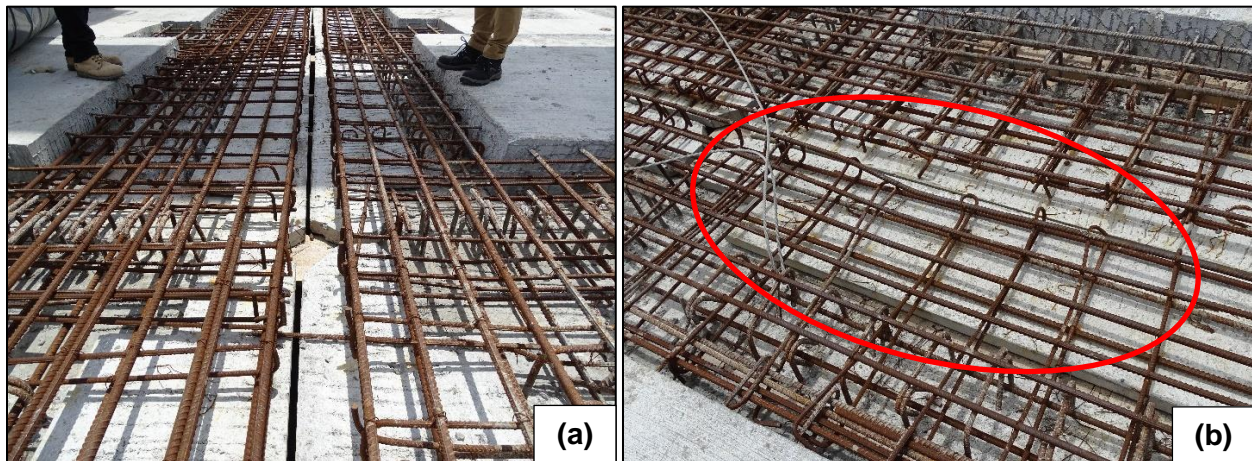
Juntas donde la rótula de continuidad estaba en proceso de construcción. (a) Se observó el uso de placas prefabricadas como encofrado inferior; aún no se habían colocado las dovelas de acero inoxidable. (b) Acero de refuerzo de una de las juntas deformado y desplazado.
